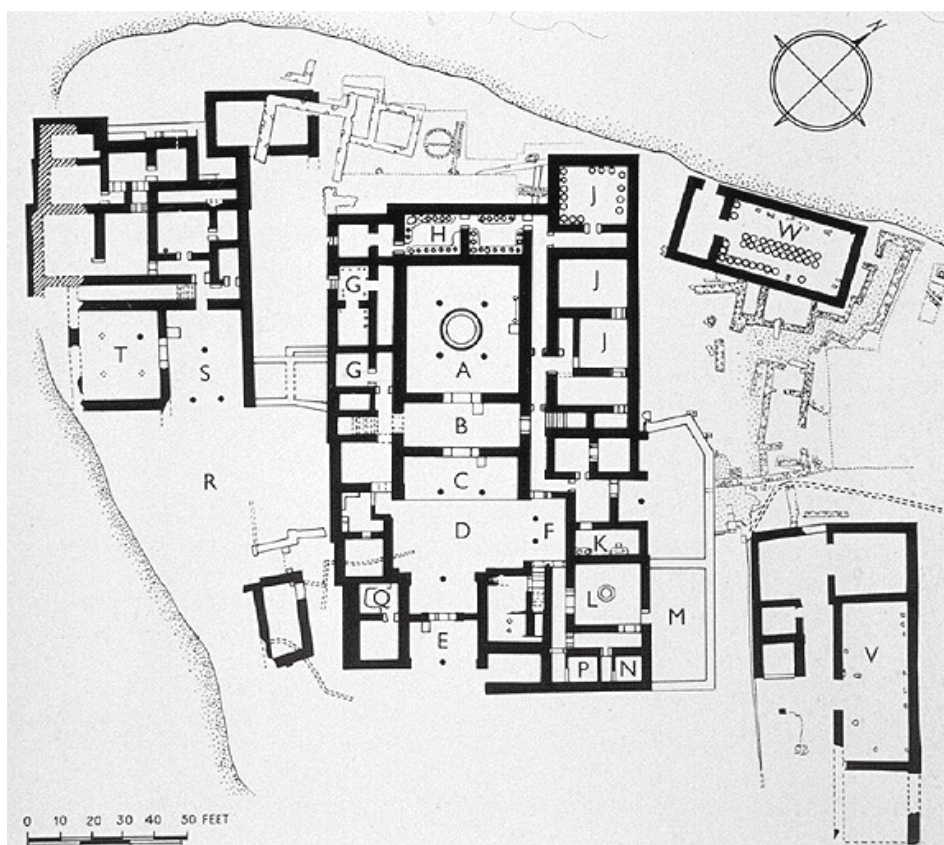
Pianta del palazzo di Pilo (1300-1200 a.C.).
